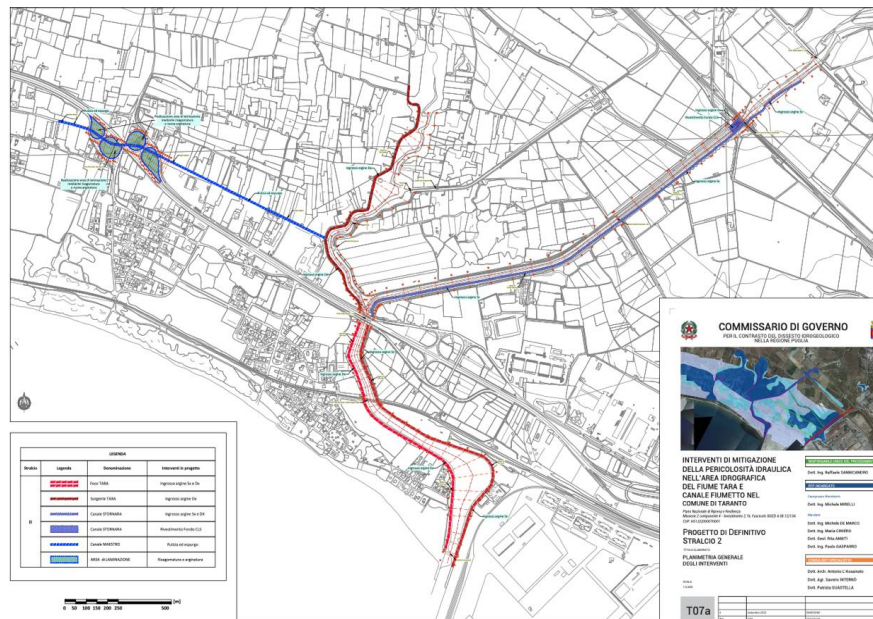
Planimetria generale degli interventi in scala 1:5000
